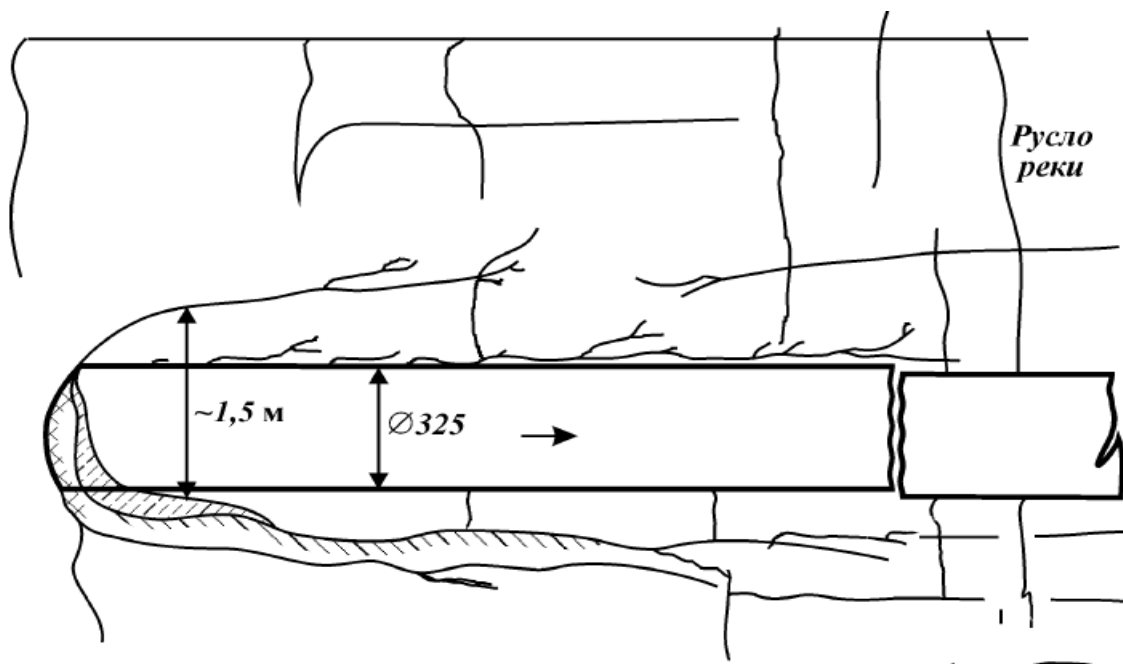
План разрыва трубопровода в условиях морозного растрескивания грунта
